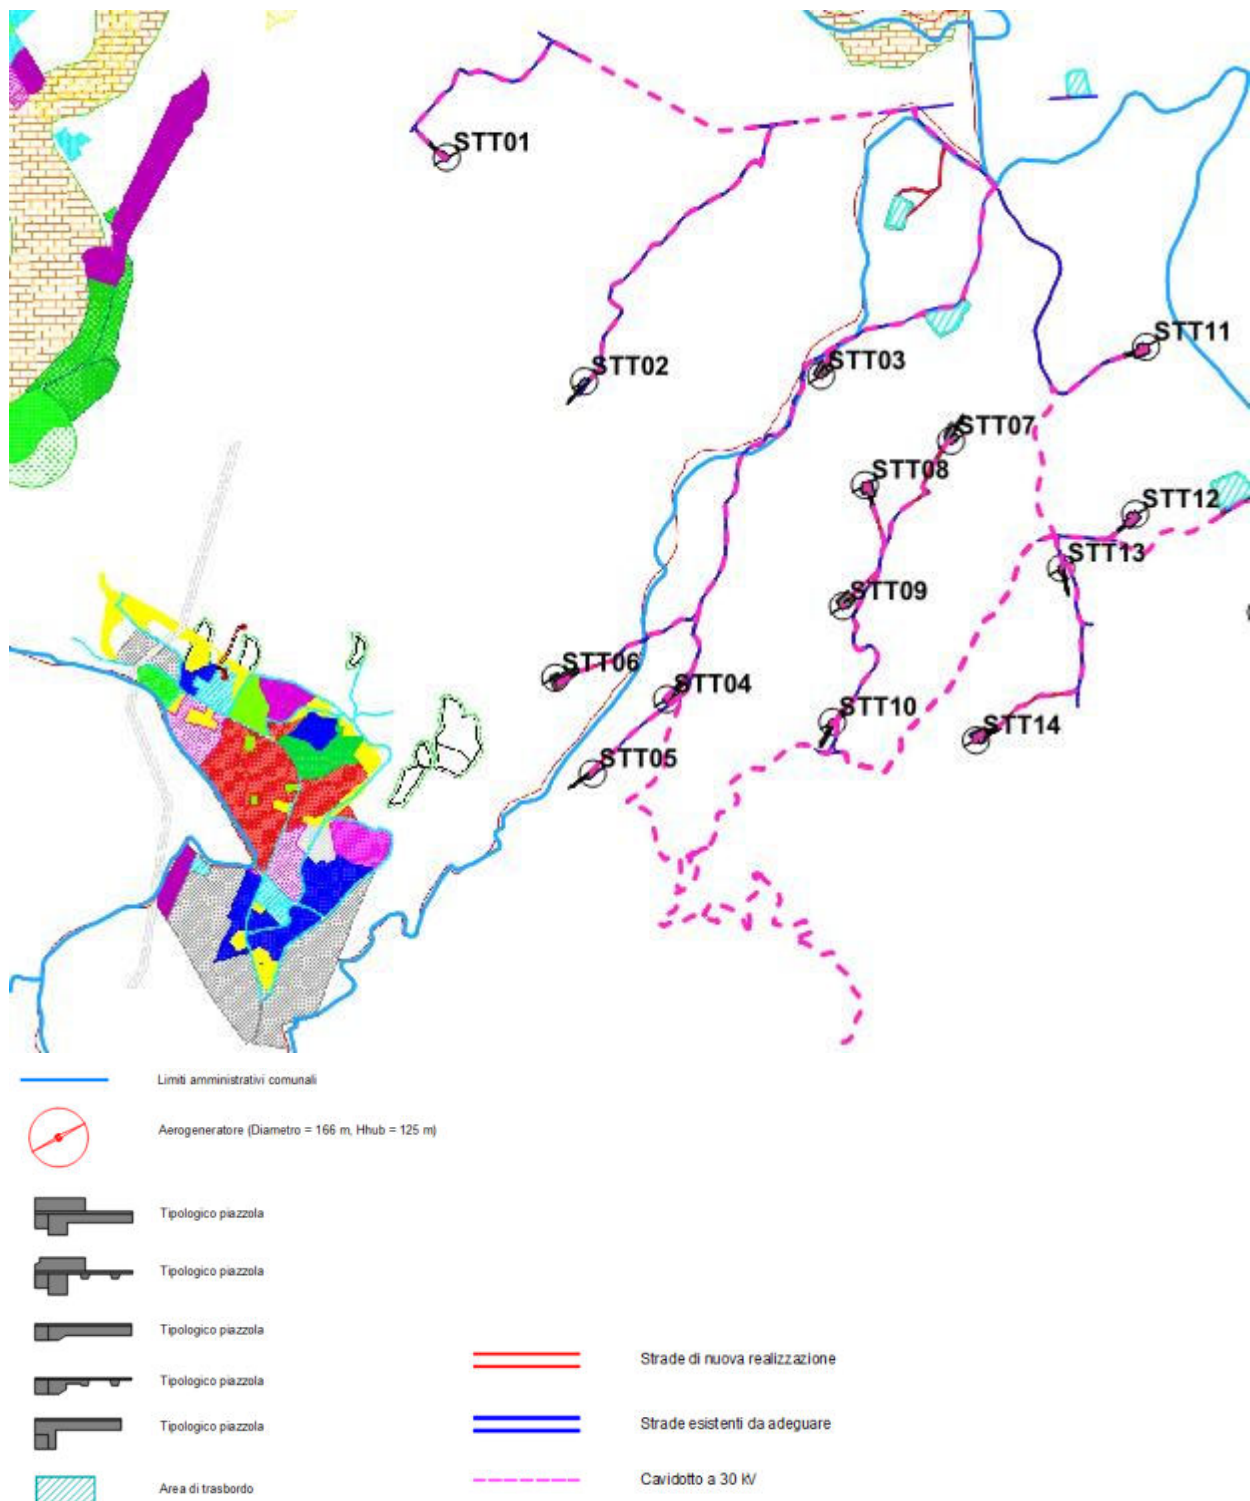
Inquadramento su stralcio della tavola di zonizzazione del PRG di Spezzano Albanese con il layout di progetto
